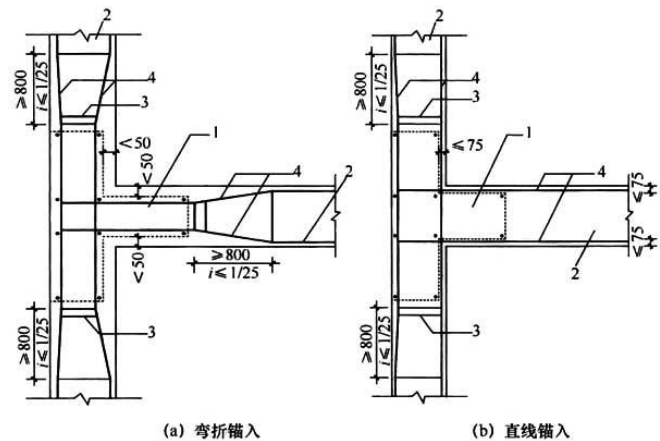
框架梁纵向钢筋锚入节点区的构造
